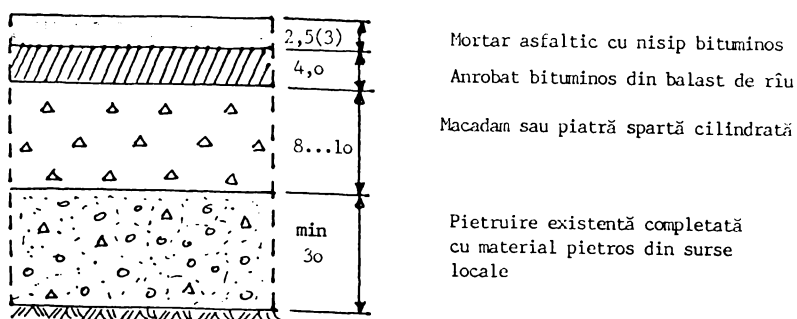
Structura rutieră realizată prin aplicarea îmbrăcăminților bituminoase ușoare pe drumurile locale din județul Sălaj
